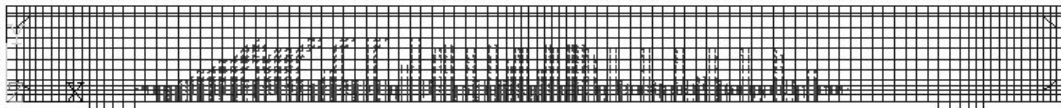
Dalle 2A Schéma de fissuration
